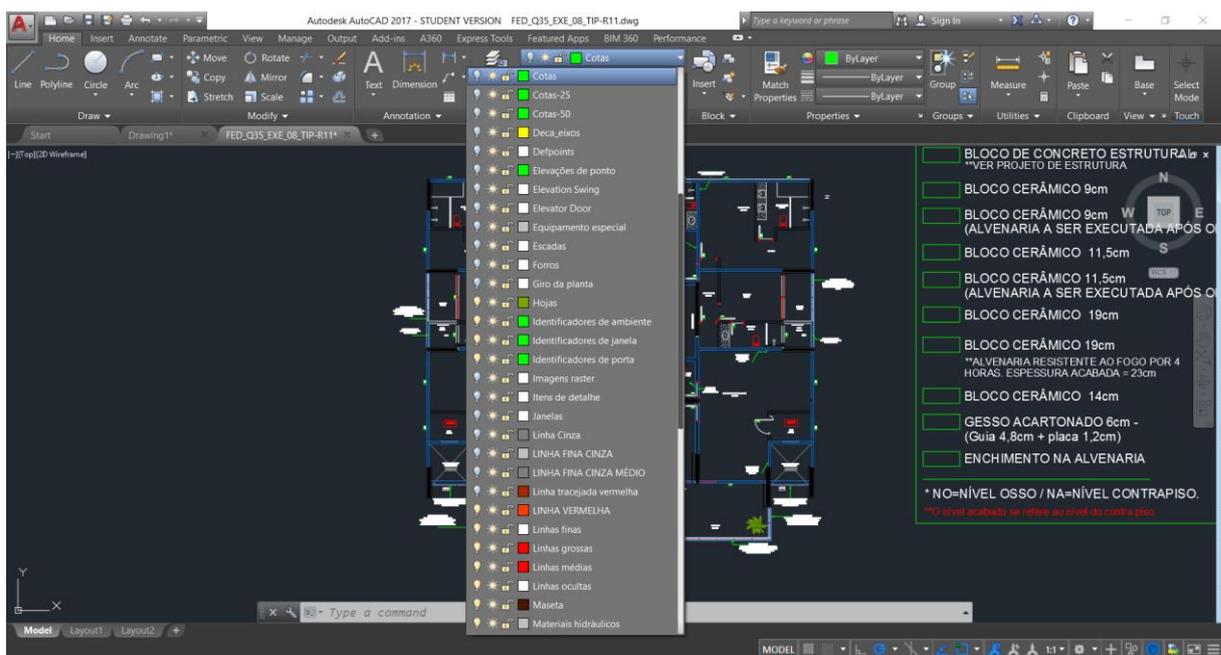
Projeto em formato DWG, Planta Baixa Pavimento Tipo.
